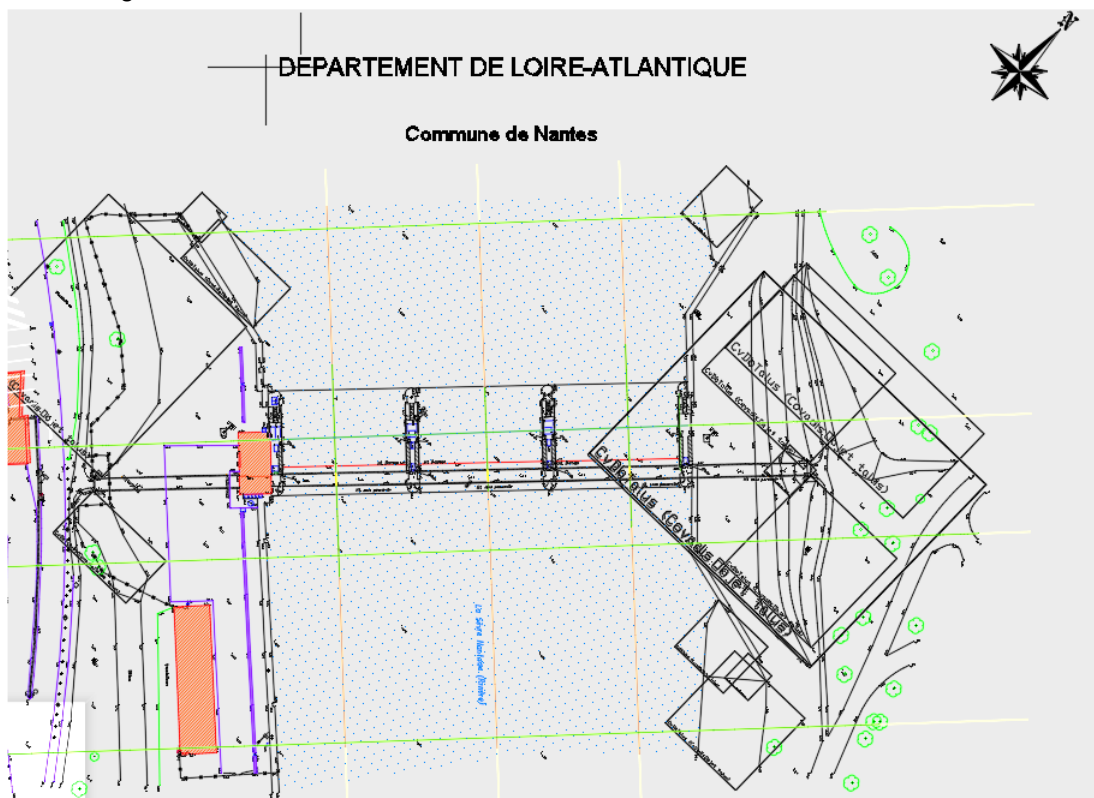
Plan du barrage de Pont Rousseau (source : FIT Conseil)
